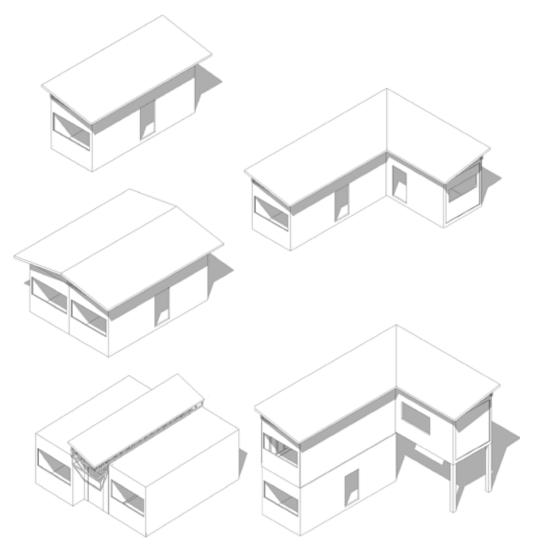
Versatilidad del sistema Constructivo FUENTE: Autoría propia
